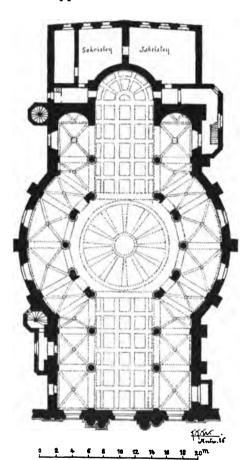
Notre Dame d'Hanswyk zu Mecheln. Grundriss.
